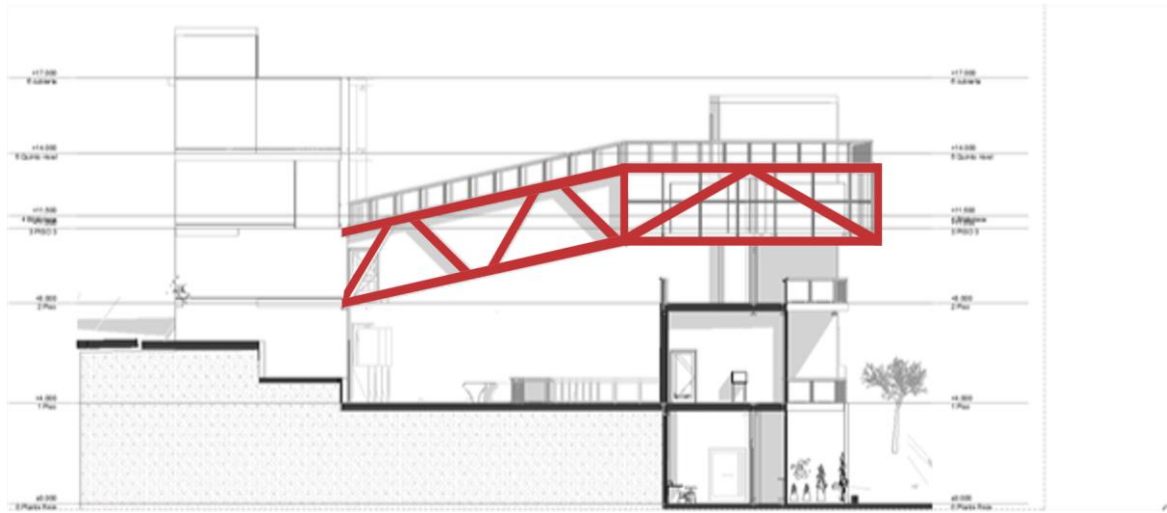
Viga viendeel en puente y mirador. Imagen del autor
